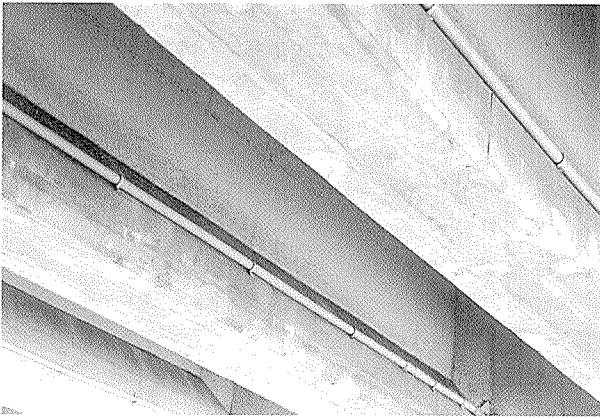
電気防食の施工箇所状況（施工 6 年後）
